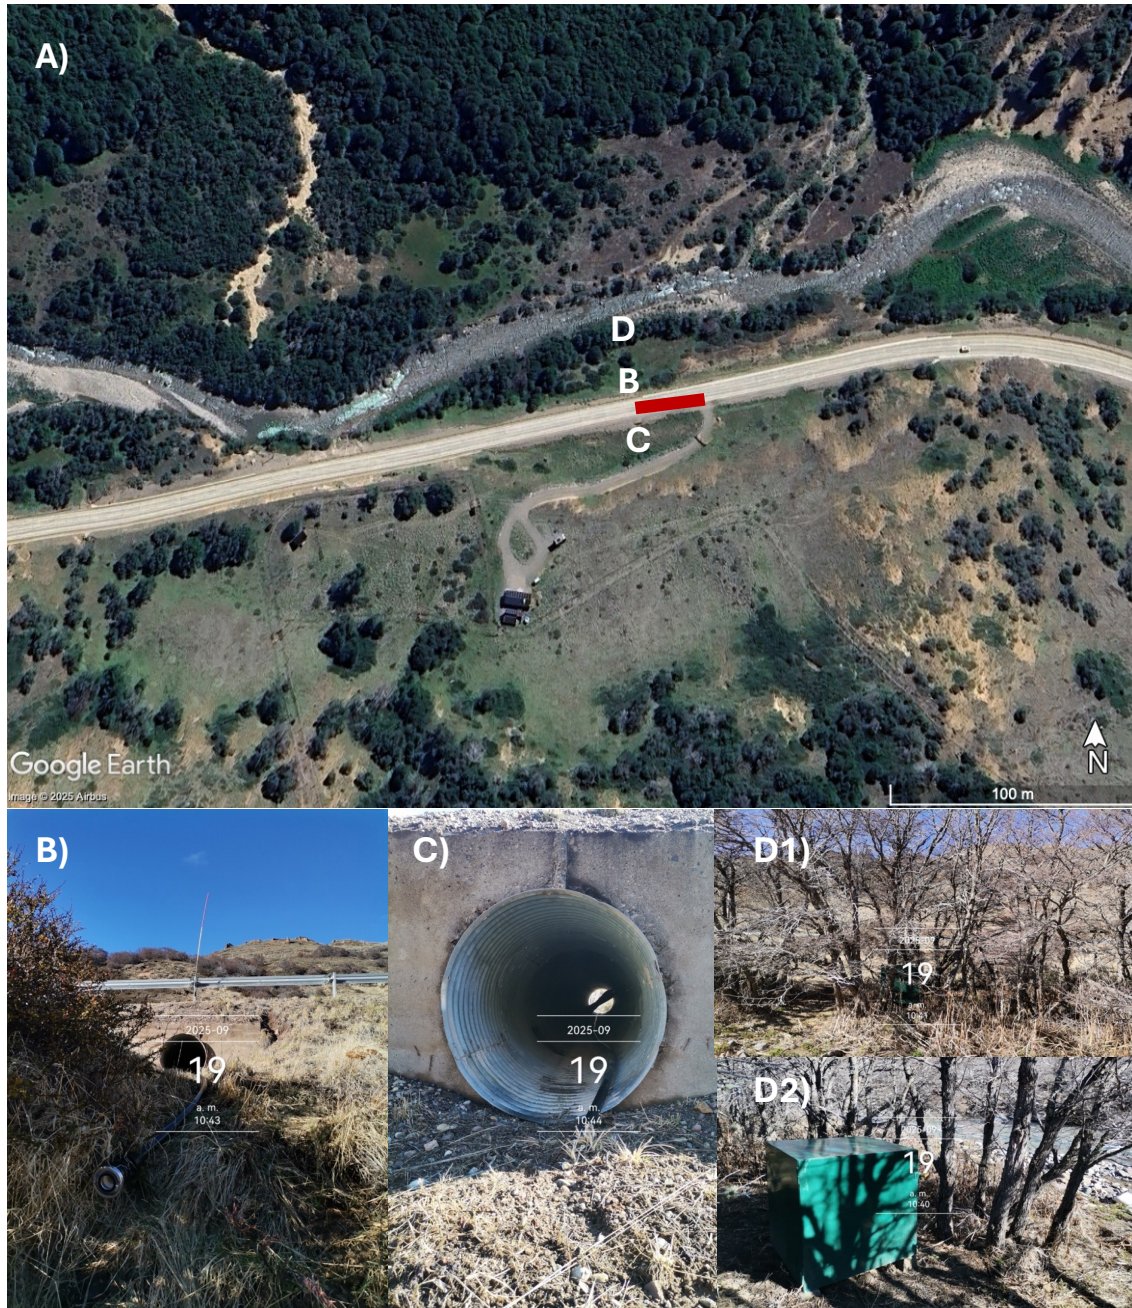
A) Vista general del Centro y las intervenciones reportadas (la línea roja indica los 30 metros de distancia entre la entrada al Centro y la alcantarilla donde está la tubería). B) Vista norte de la alcantarilla. C) Vista sur de la alcantarilla. D) Estructura similar a una bomba de agua en vista general (D1) y detalle (D2).
